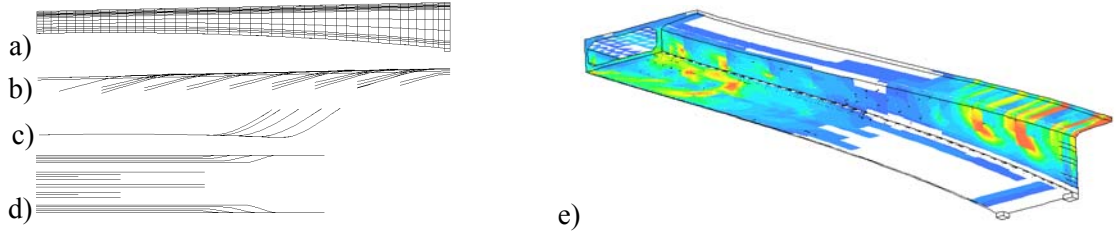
Modelo 3D de meio vão da ponte: a) Alçado; b) alçado dos cabos consola; c) alçado dos cabos de continuidade inferiores; d) planta dos cabos de continuidade inferiores; e) vista do modelo 3D na rotura e respectivos mapas de fissuração.
